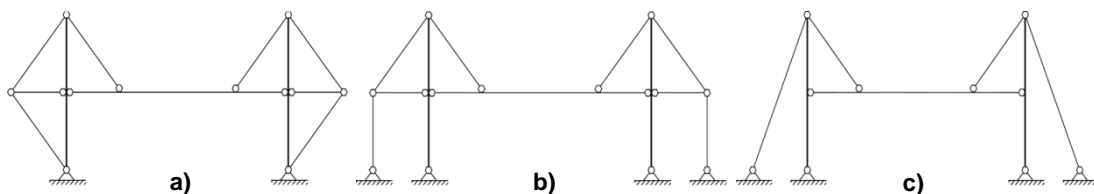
Esquema estrutural de pórticos com vigas suportadas por cabos (SECHALO, 2012)
